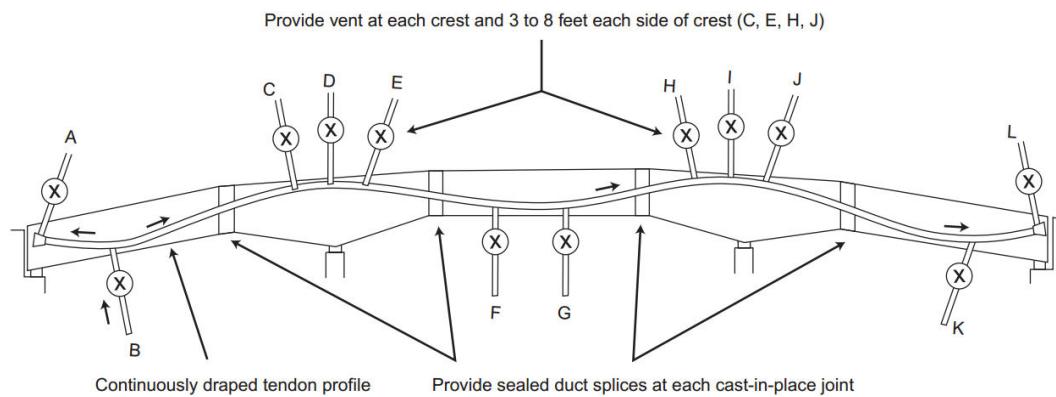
Detalles del grouting para un sistema de ducto de una viga principal empalmada de 3-tramos en caída.
